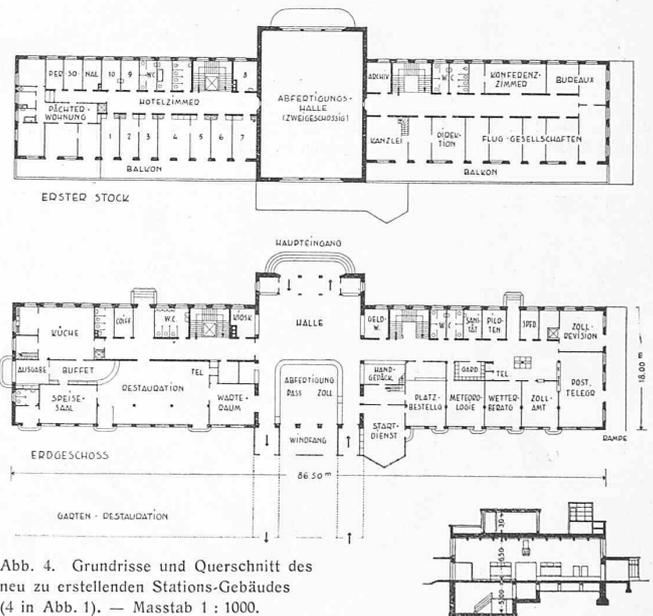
Grundrisse und Querschnitt des neu zu erstellenden Stations-Gebäudes (4 in Abb. 1). — Masstab 1 : 1000.
